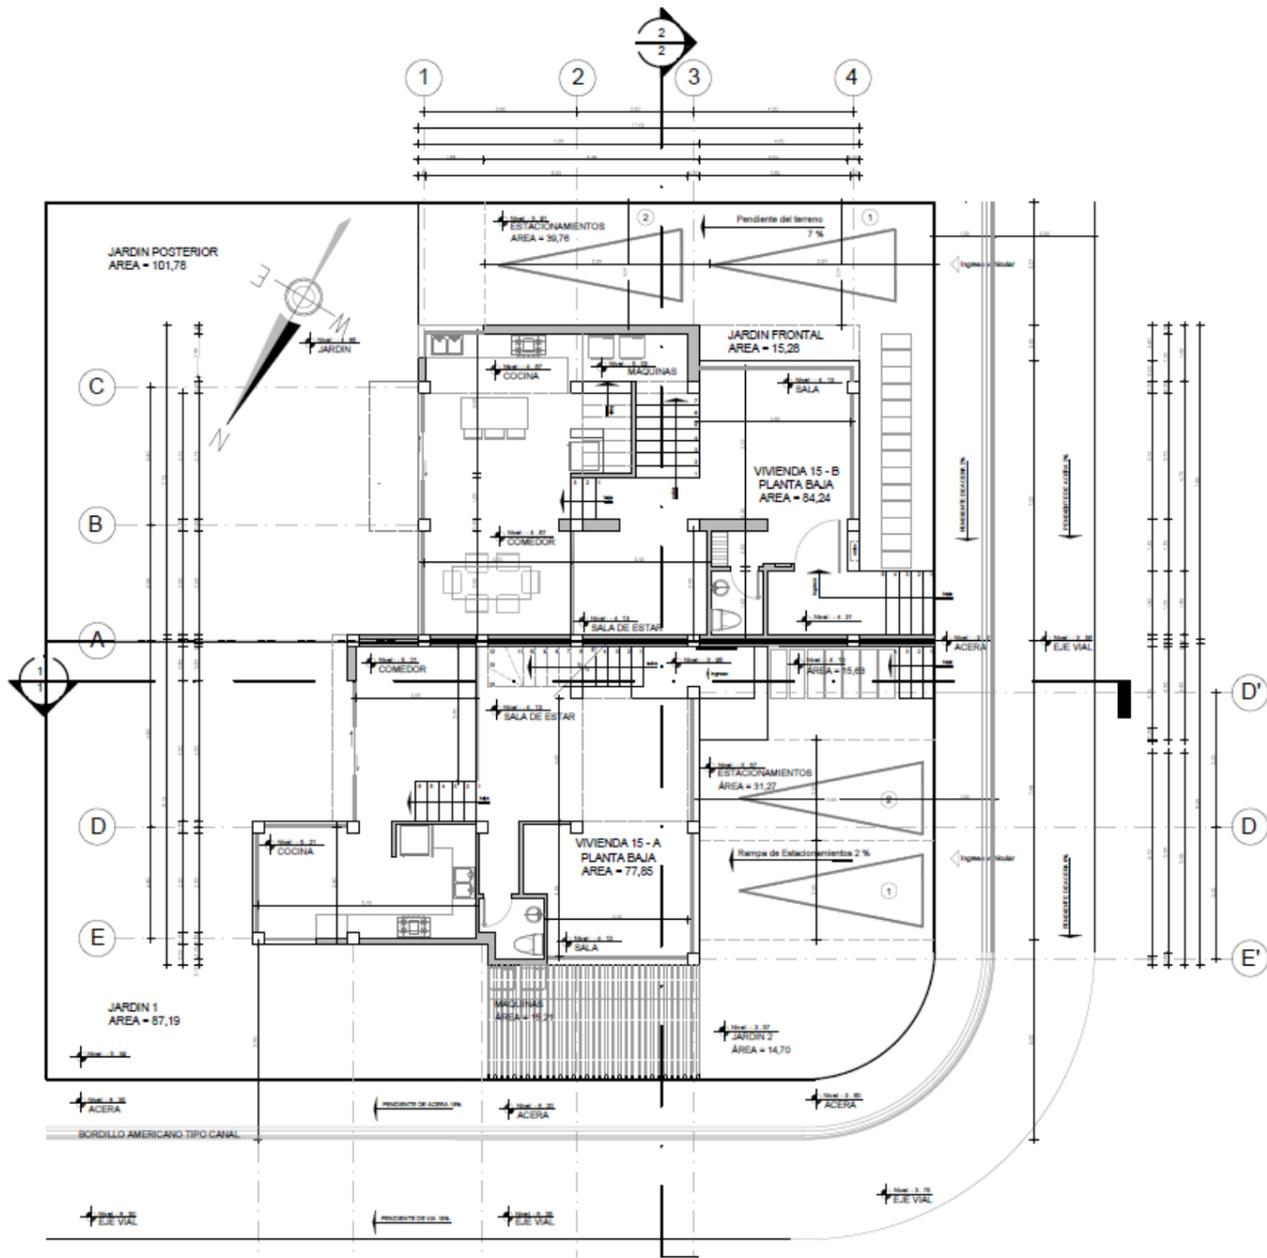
Planta baja de las casas 15 A y 15 B, (Casas Adosadas)
